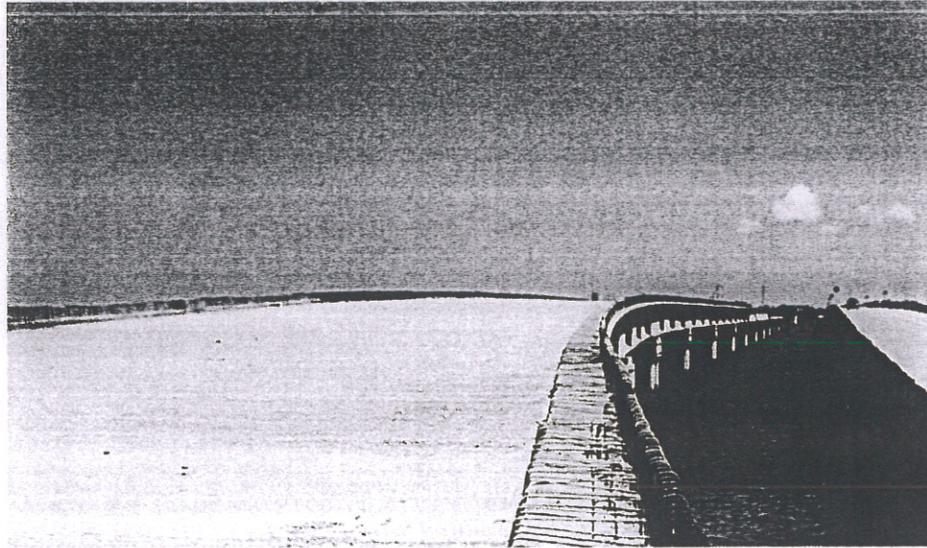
Losa de concreto construida, a la derecha el puente actual.
